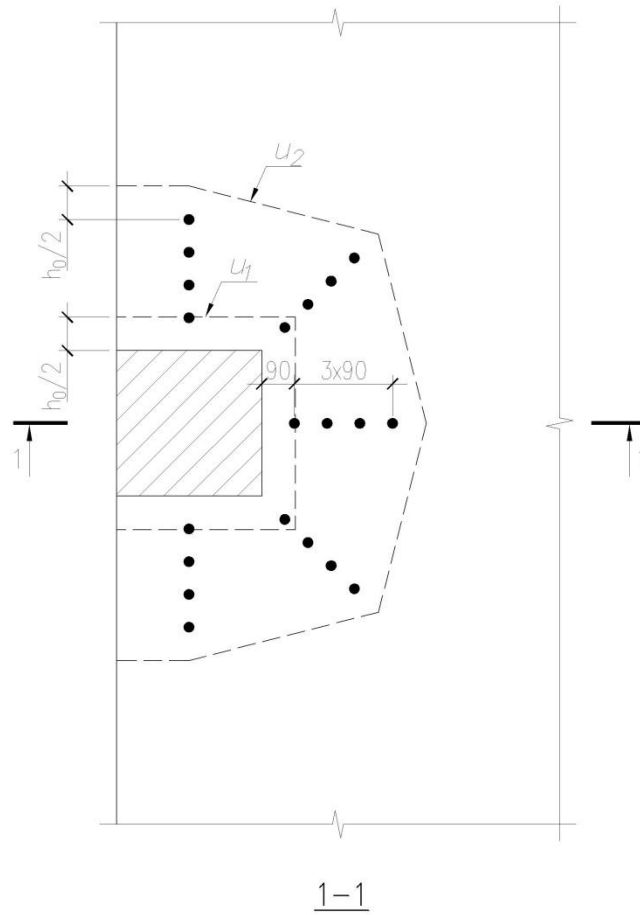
Схема усиления плиты перекрытия на продавливание.
